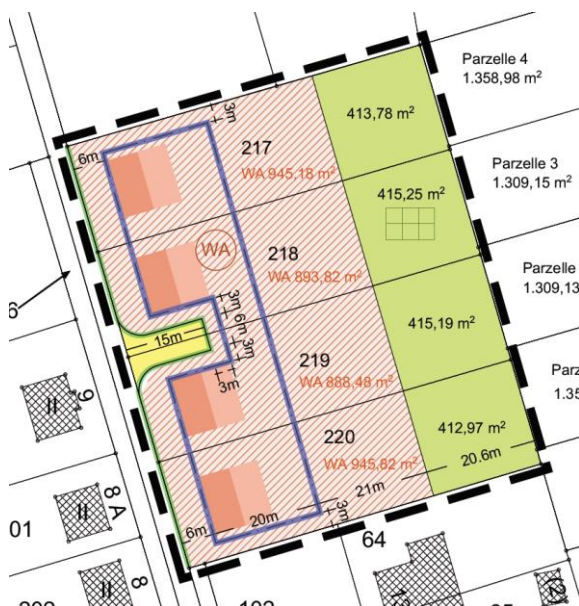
Vorentwurf des Bebauungsplans (CUBUS BAUPLANUNG, Stand 06/2016)
